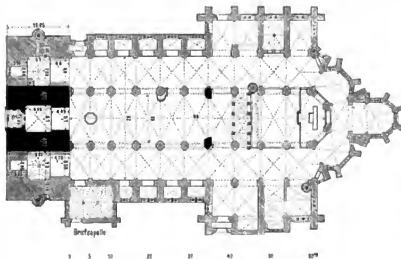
St. Marienkirche in Lübeck, Grundriß.
